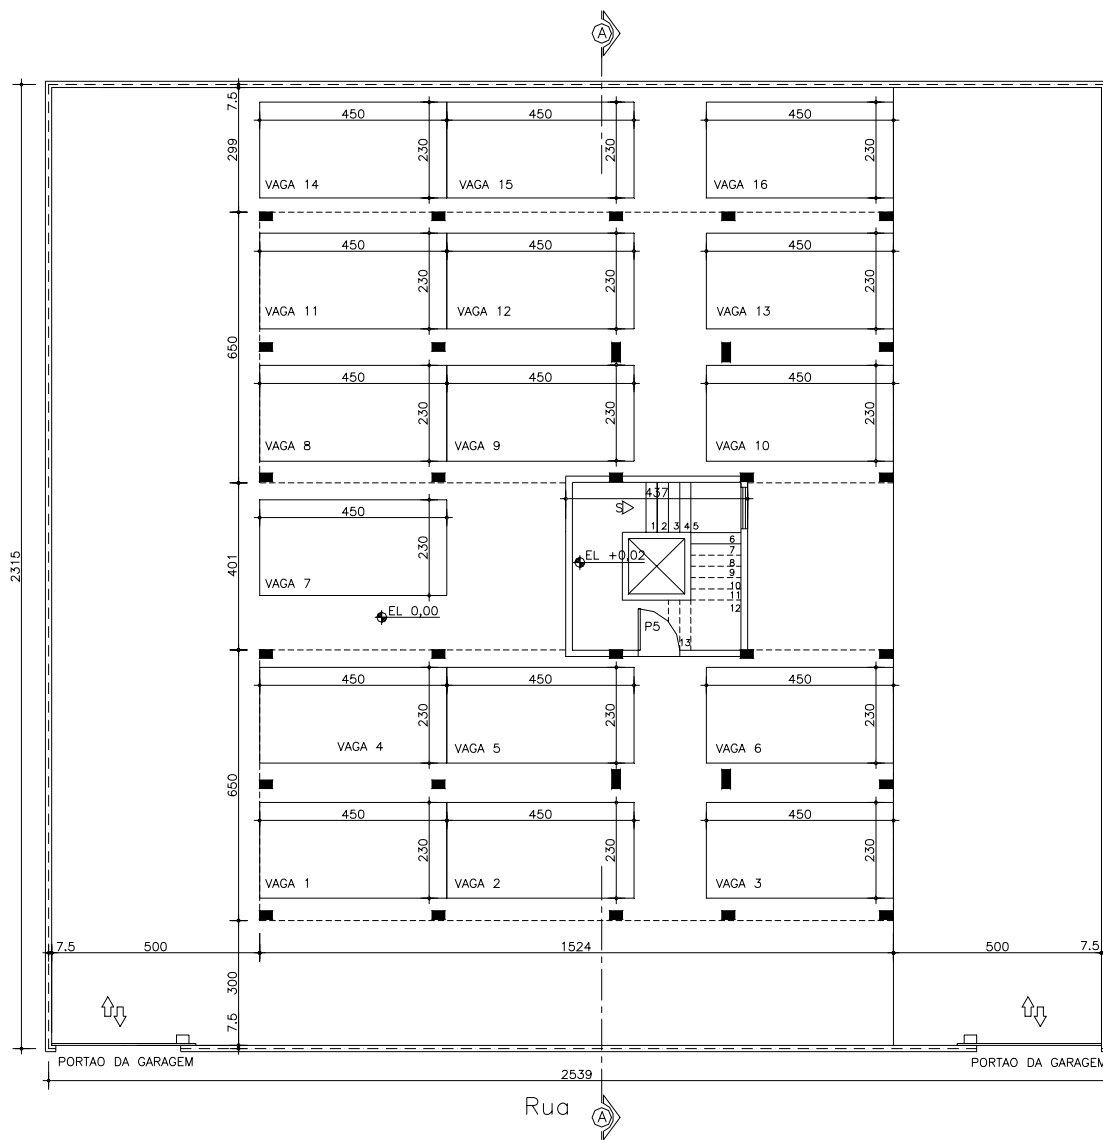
Prédio “A” – Opção 3 – Planta da Garagem
